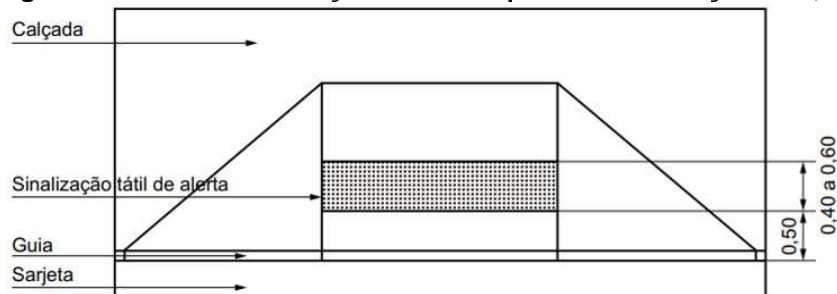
Rebaixo de calçada com rampas com inclinação entre 5,00 e 8,33%
